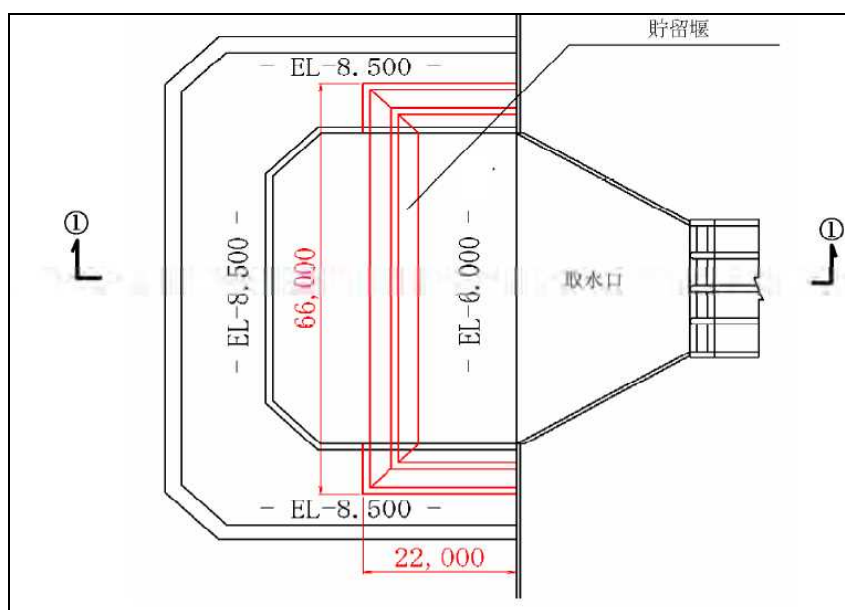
貯留堰の平面図 (九州電力 川内 1, 2 号炉)
